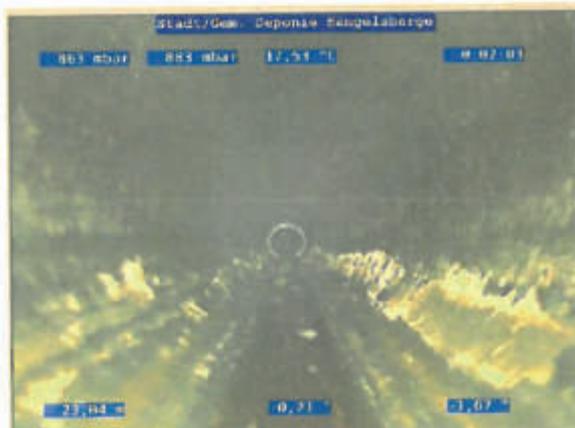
Foto Rohrleitung Sickerwassersammelrohr Haltung S4-S3
